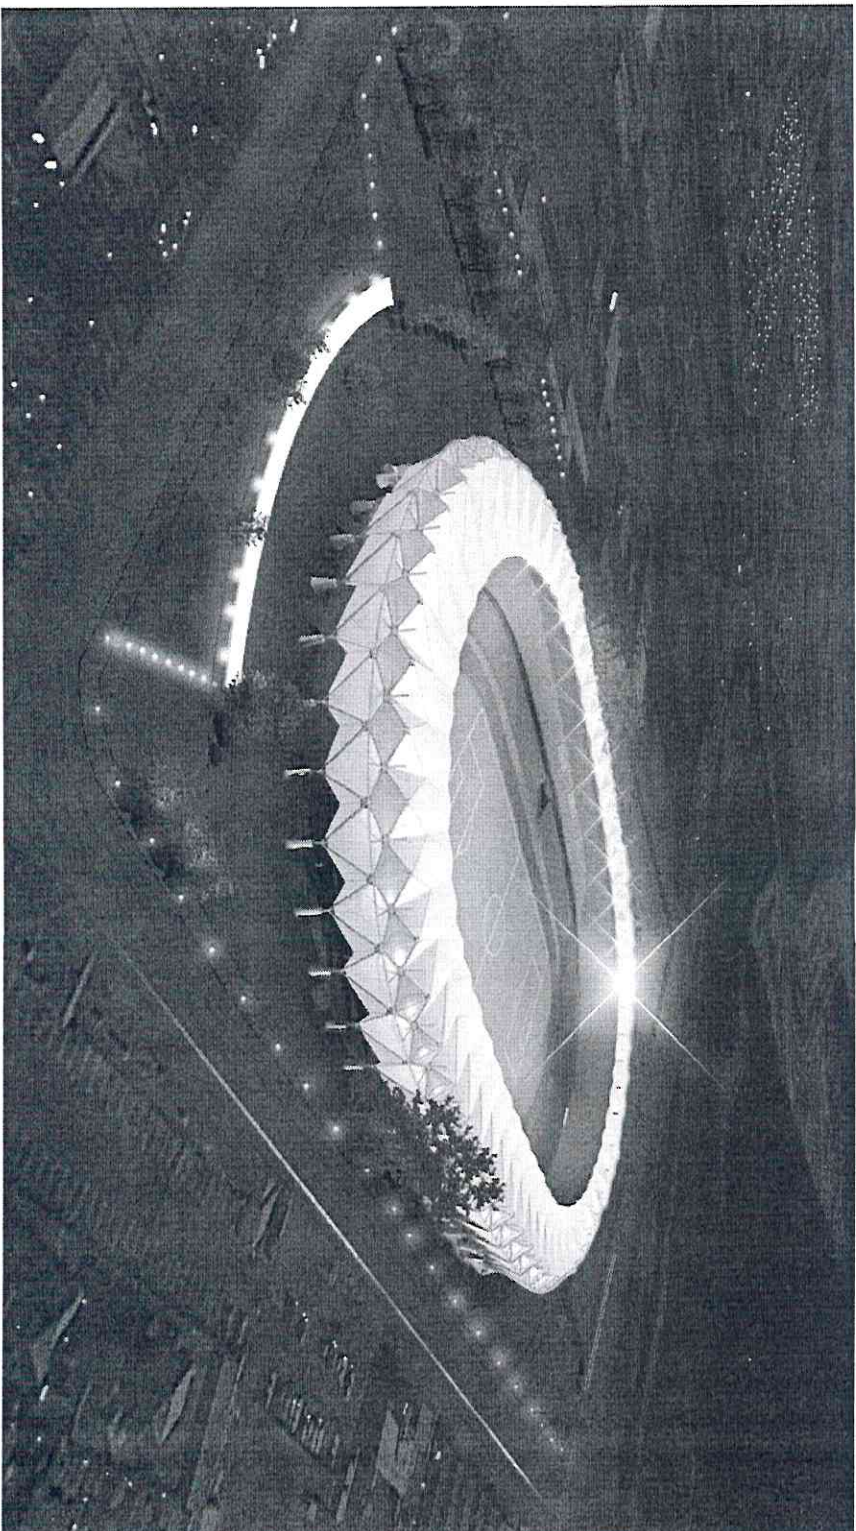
IMAGEN | VISTA EMPLAZAMIENTO CUBIERTA Y ACCESO
